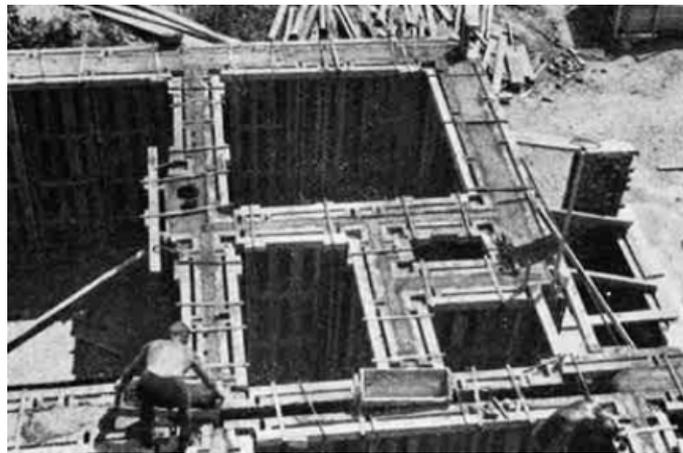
Stüttbetonbauweise nach dem System Steppan
